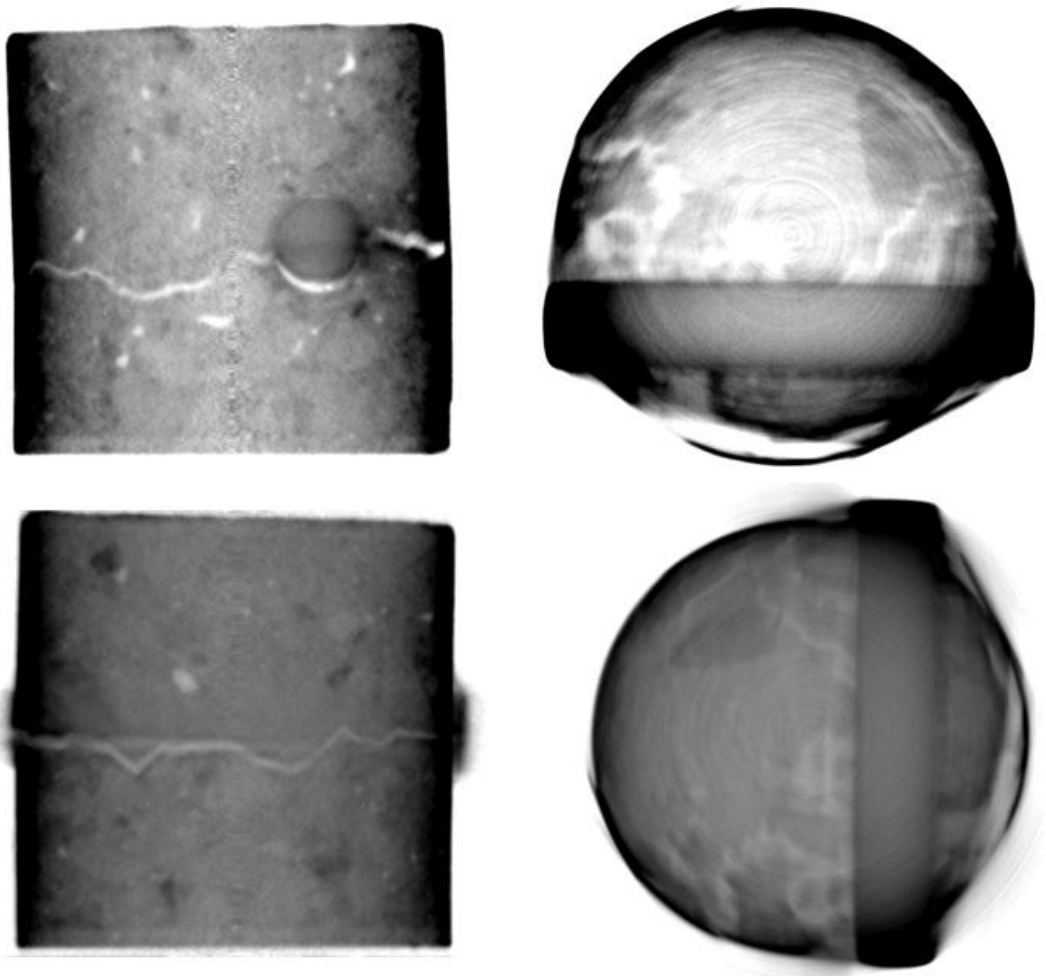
コンクリート内で腐食を加速させた試験体における縦及び横断面像
